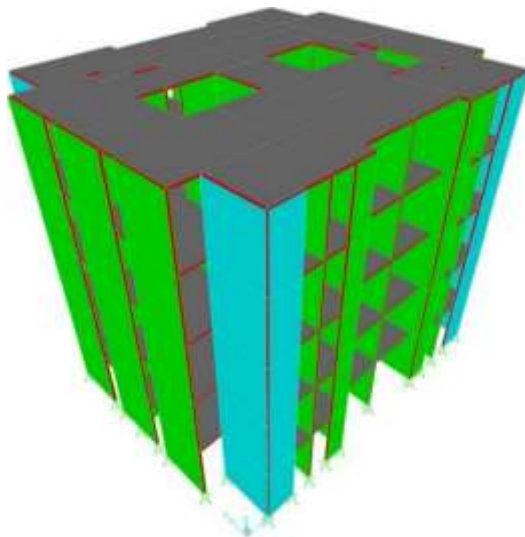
Modelo 3D SAP edificio sistema de muros en mampostería reforzada.
